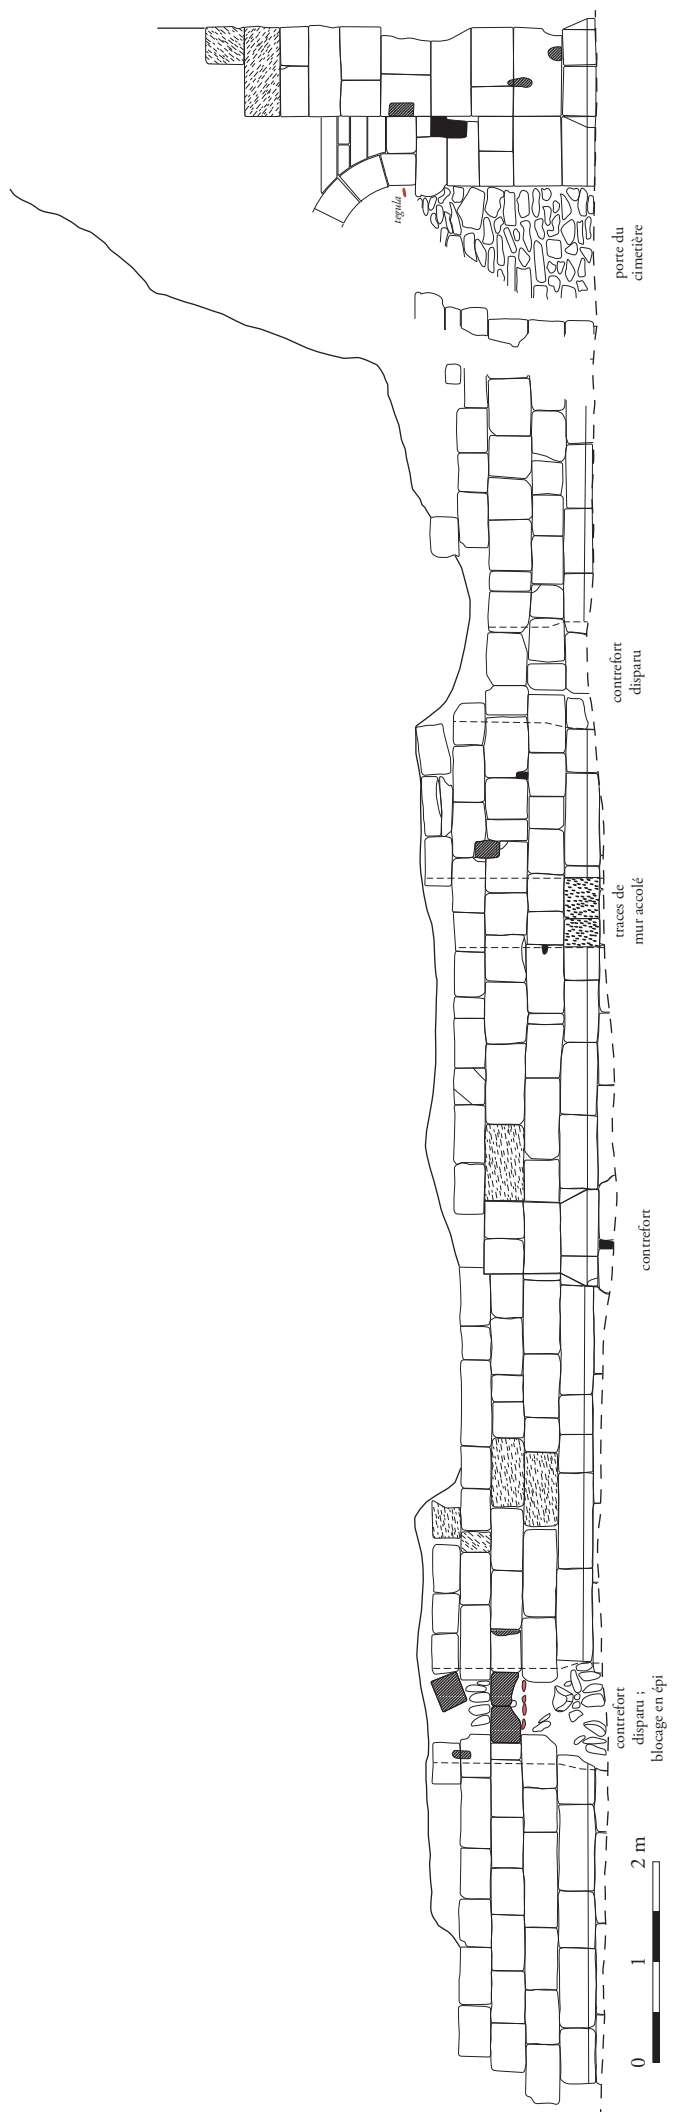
Abbaye de Haute-Seille. Parement extérieur du mur gouttereau nord (relevé Guillaume Huot-Marchand et coll. ; observations Marie Nique ; DAO Louis Defosse, Cédric Moulis). [A3]
